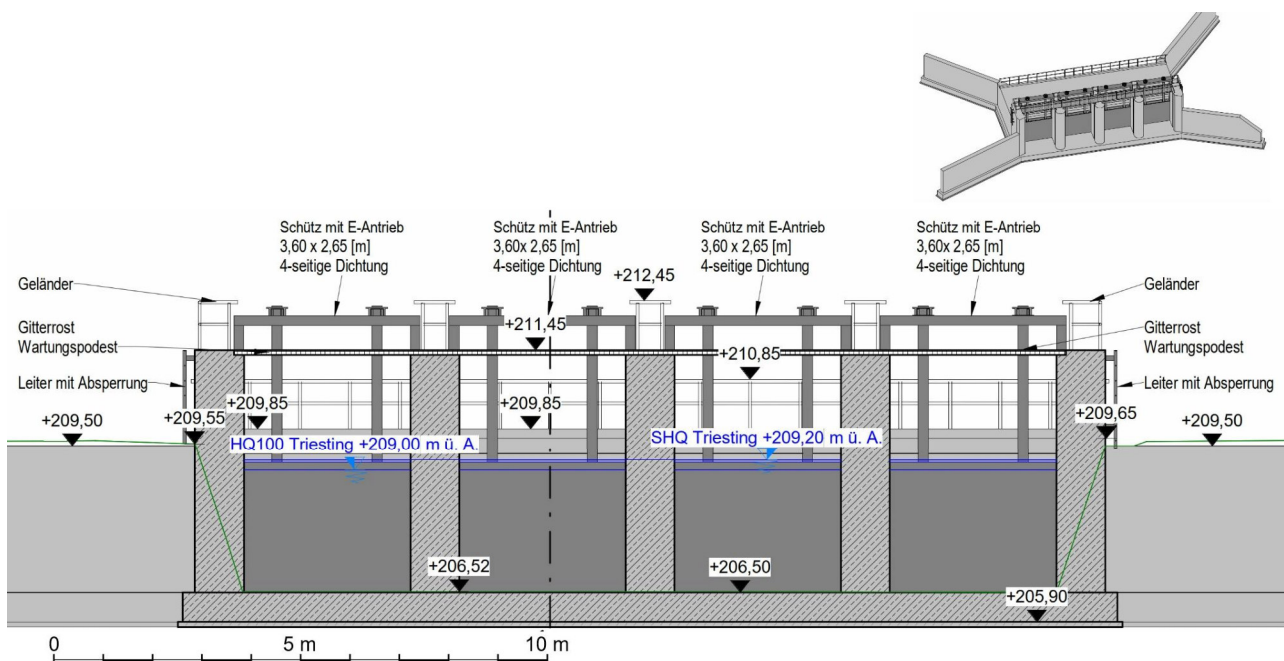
Schnitt durch das Dotationsbauwerk (Quelle: Einreichunterlagen Einlage 026)
